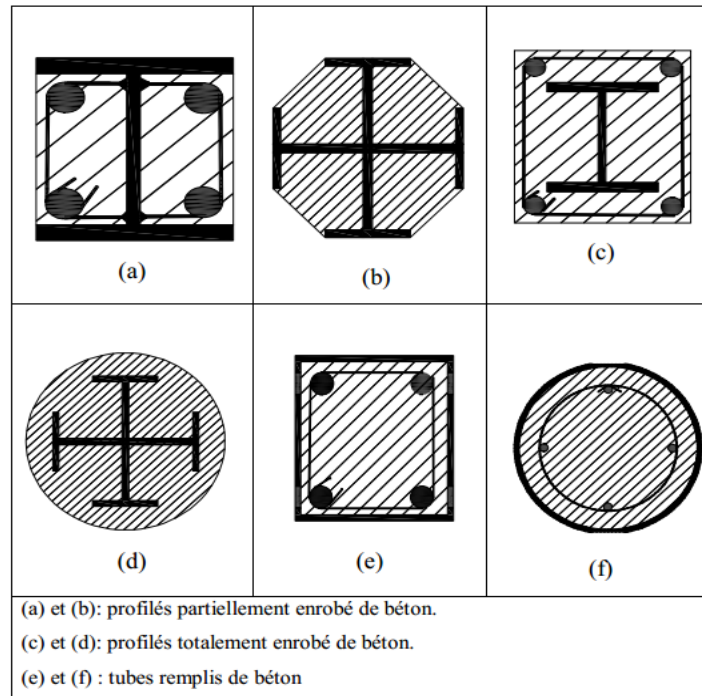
Exemples de sections transversales de poteaux mixtes [16].
